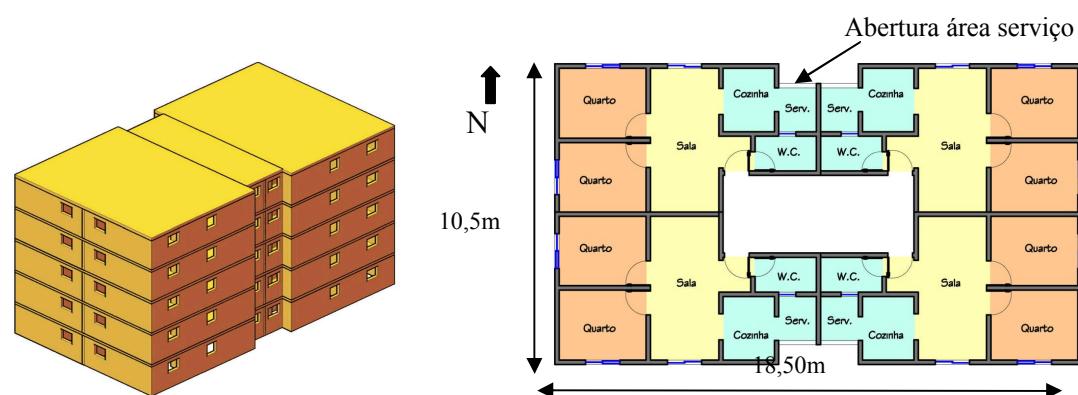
Visualização em 3d e em planta baixa do edifício do estudo de caso 2.
